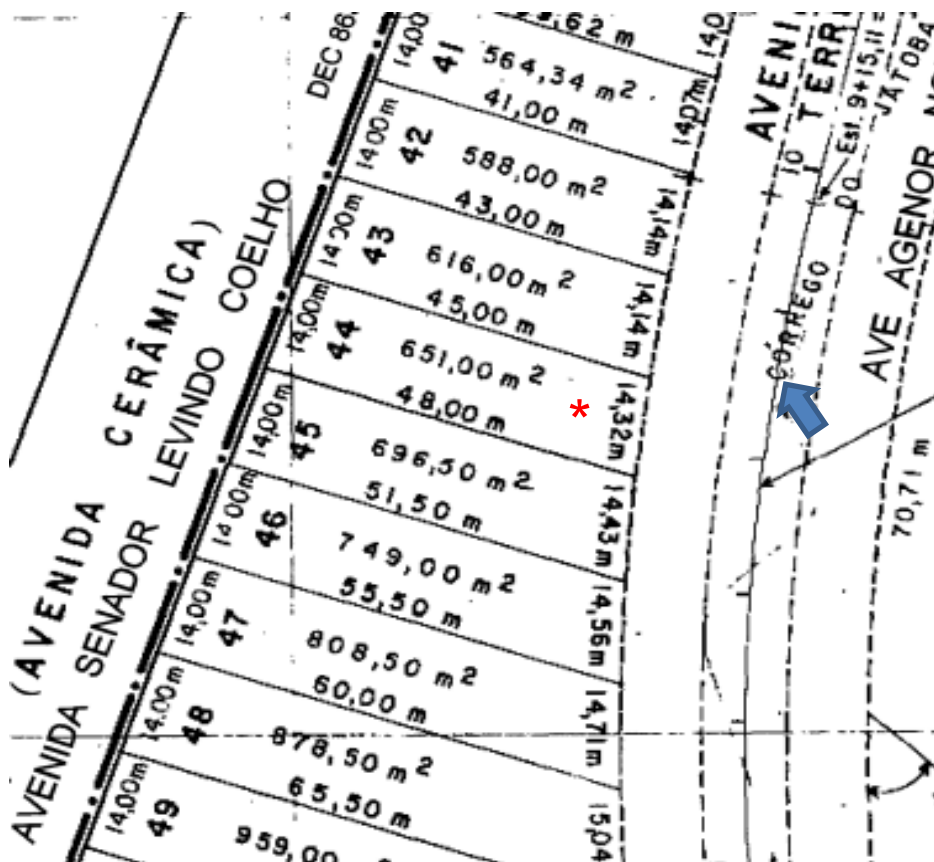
Lote 44 (*) e córrego do Jatobá (seta azul) conforme Planta CP-251009M (Fonte: Adaptado de SIURBE/2023).
